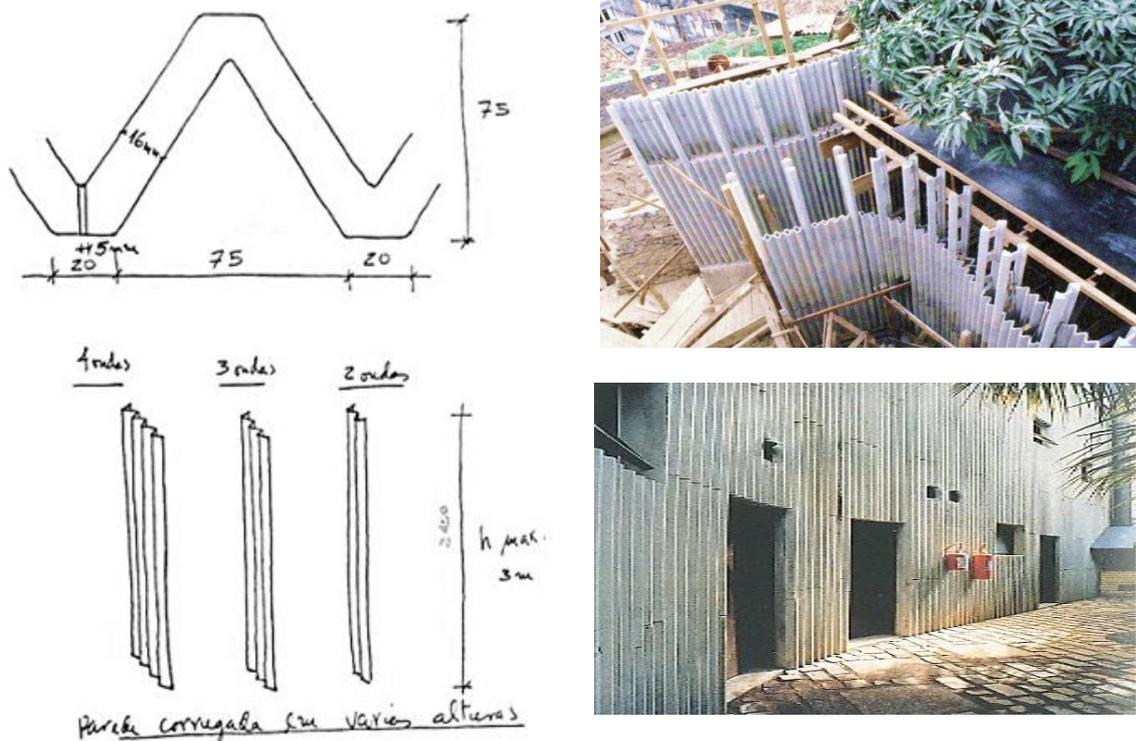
Diseño y bosquejo de una pieza premoldada, y su posterior utilización en obra
